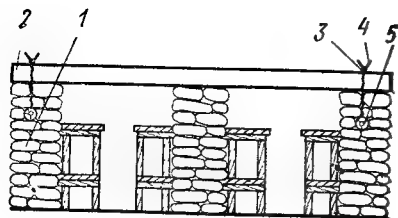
Поперечный разрез убежища со стенами из грунтонабивных мешков
